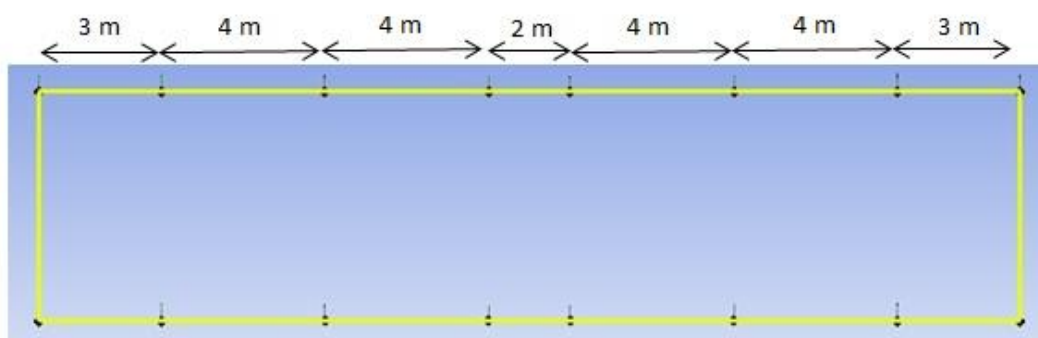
Projecção vertical e dimensões do elemento anelar estrutural
